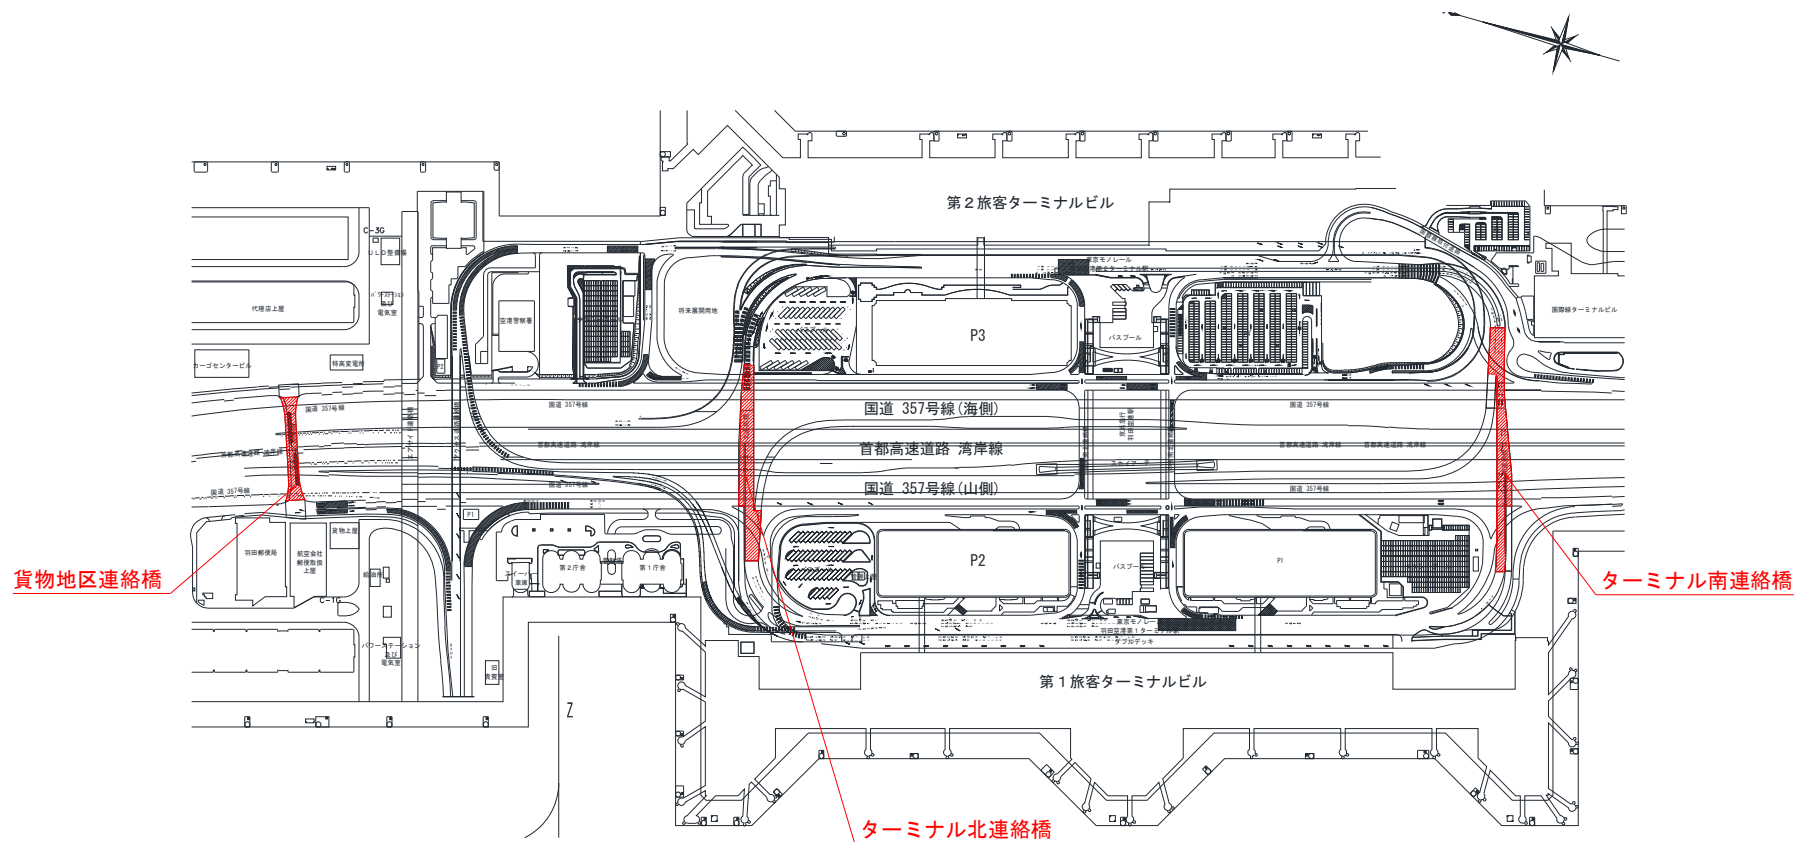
鉄筋コンクリート床版鋼箱桁橋の位置図
